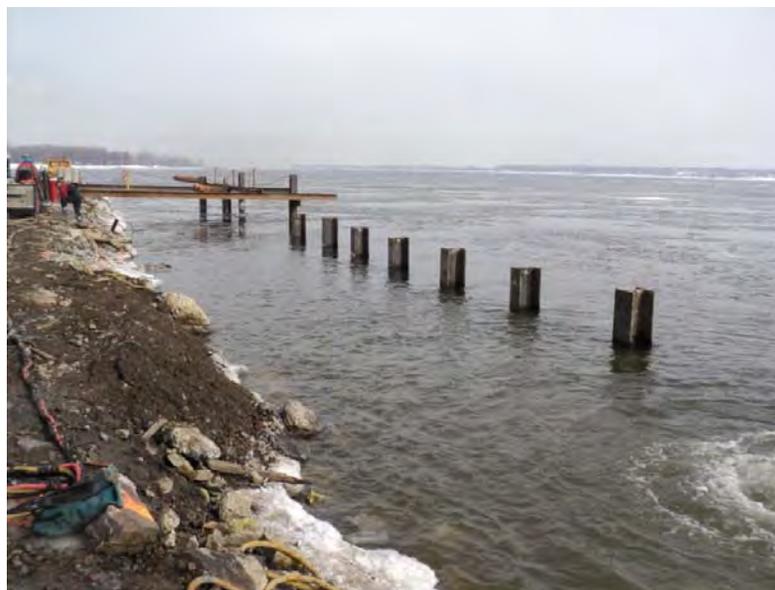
Exemple de projet de construction d'un mur berlinois
